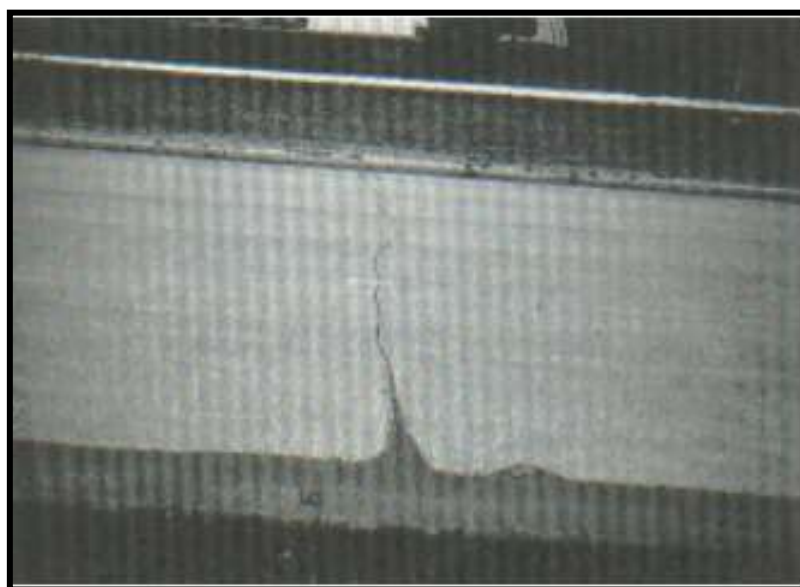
Nivel de Severidad Bajo de Grietas Longitudinales y Transversales en el Pavimento.
